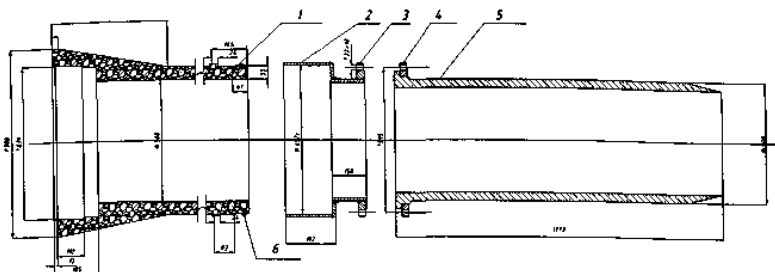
Фланцевое соединение трубопровода из НПВХ и железобетонных трубопроводов: 1 – труба из железобетона раструбная цилиндрическая с упорным буртиком; 2 – стальной переходный элемент ВР (втулочно-раструбный); 3 – стальной приварной фланец; 4 – фланец; 5 – патрубок гладкий из НПВХ; 6 – резиновое уплотнительное кольцо
